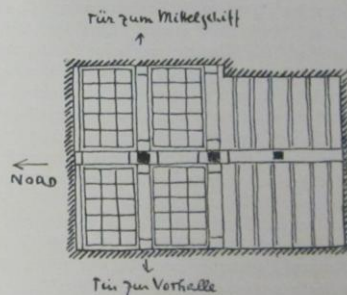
Grundriß der hölzernen Decke der inneren Vorhalle der Kirche zu Debra Damo.
